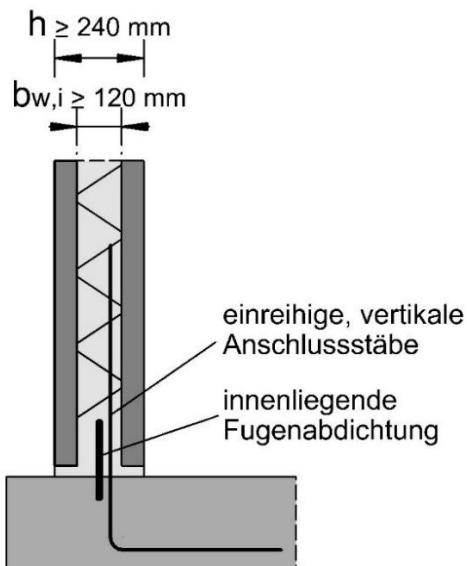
Elementwand mit Wanddicke von 240 mm und innenliegender Fugenabdichtung und einreihiger Anschlussbewehrung aus einzelnen vertikalen Bewehrungsstäben
